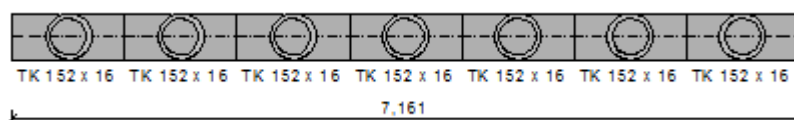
Krajní trubka 9. pilíře (pravá) – 3.Vlastní tvar [1,975Hz]
